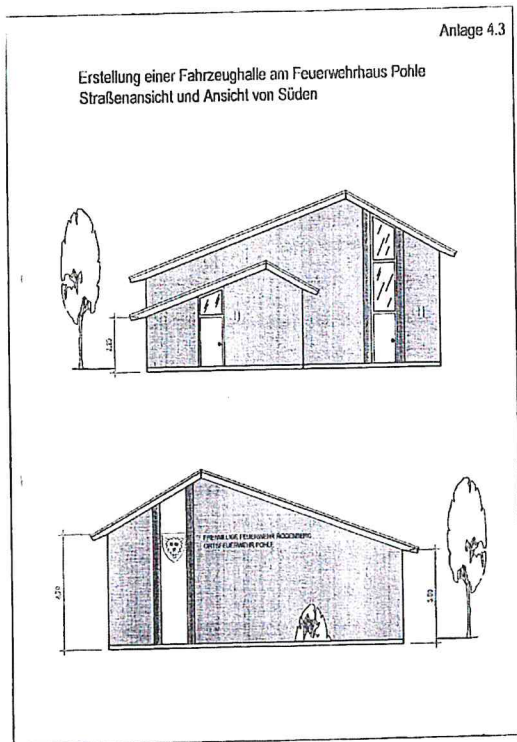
Straßenansicht / Südansicht Fahrzeughalle
